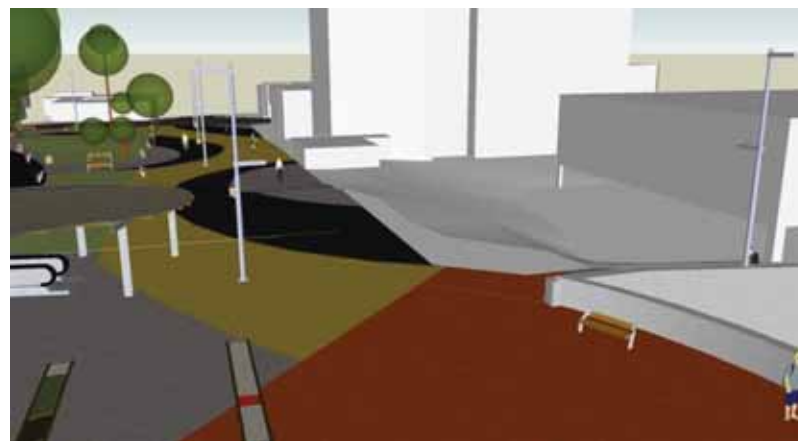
Vista da expansão do calçadão ao lado da prefeitura.
